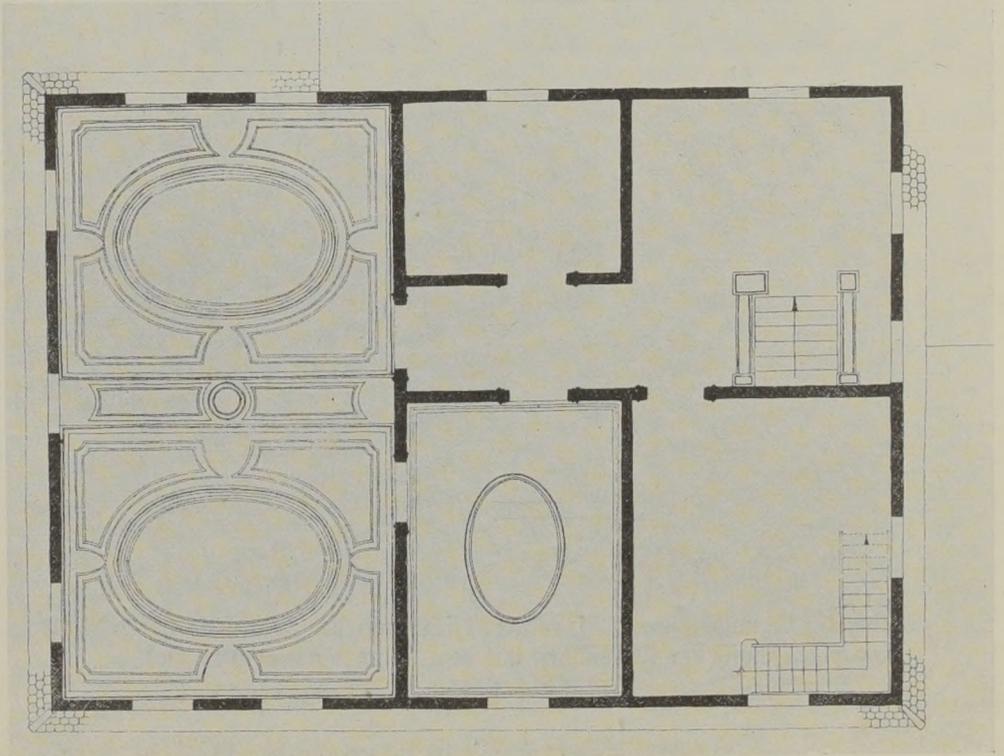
Grundriß des obersten Geschosses (Fachwerkgeschoß).
